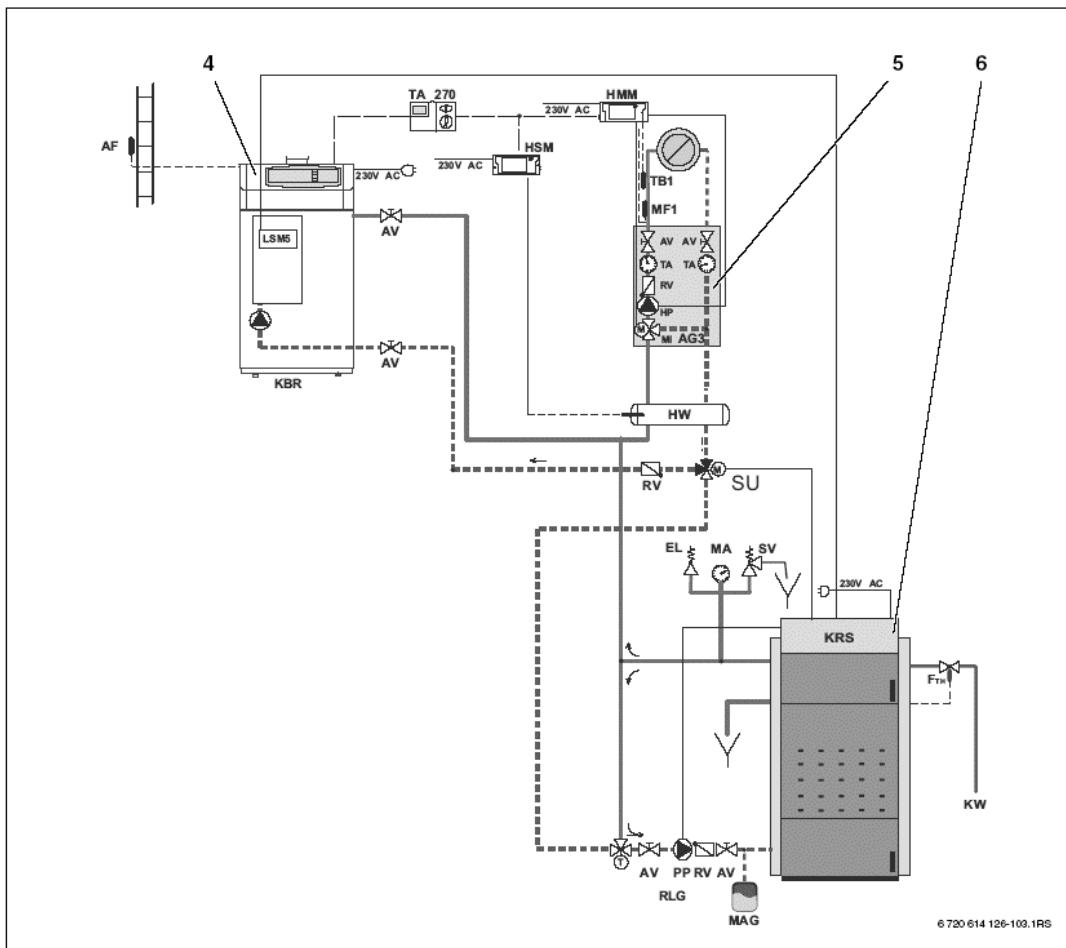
Plan hidraulic P01 cu al doilea cazan de încălzire
